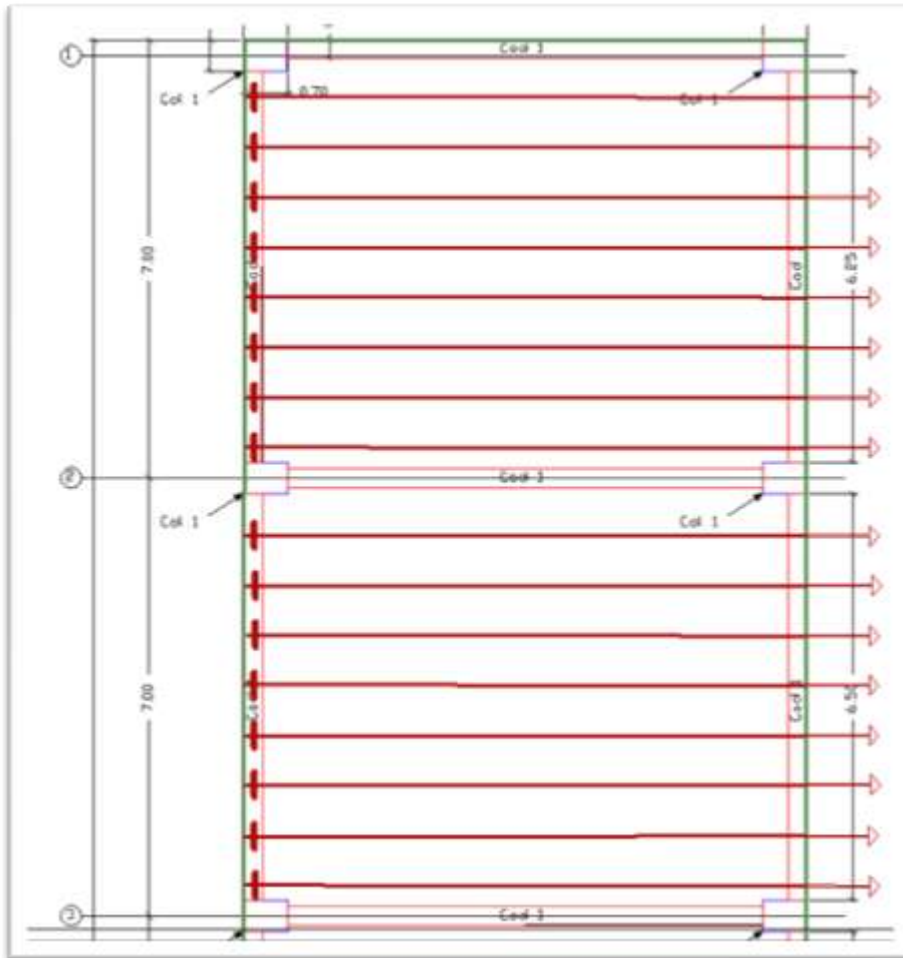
Anclajes pasivos y activos de los cables a postensar. Refuerzo inferior
